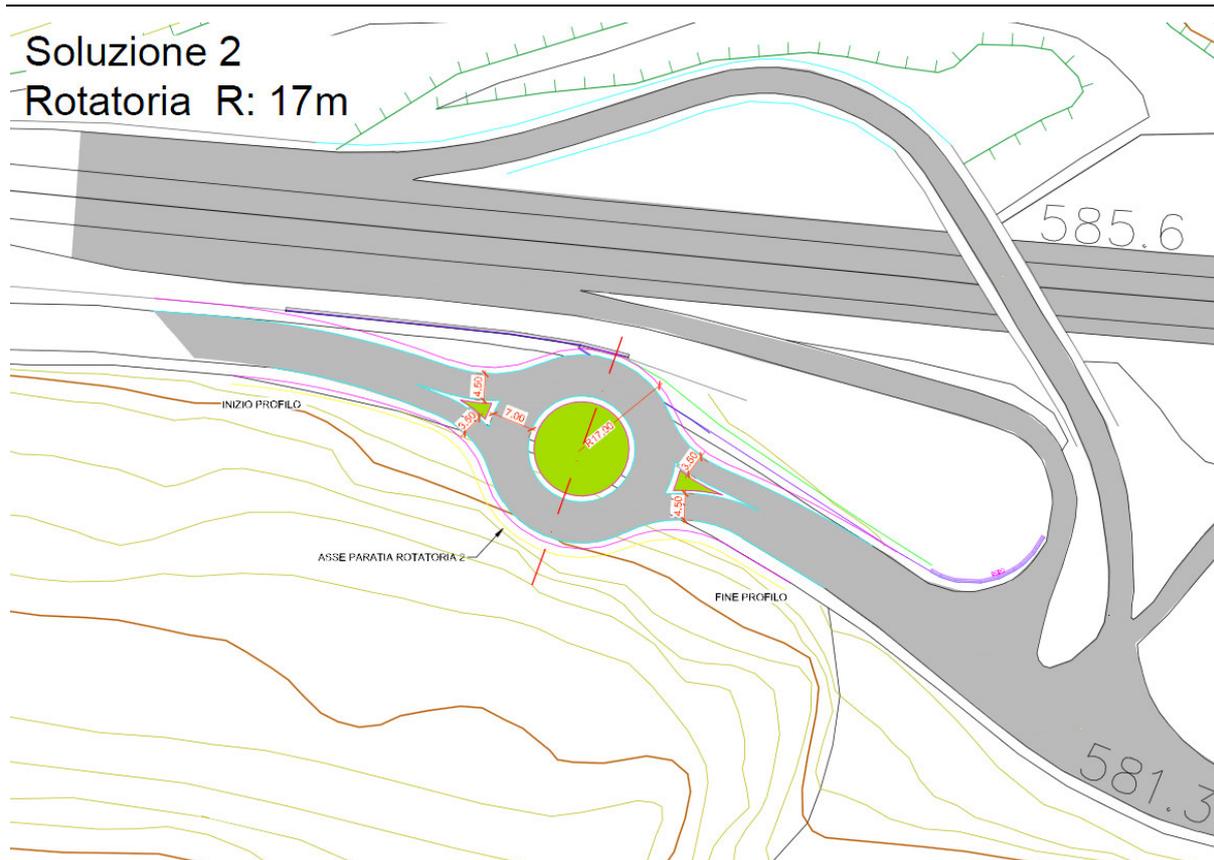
Planimetria Soluzione alternativa n. 2 rotonda r esterno = 17 m
